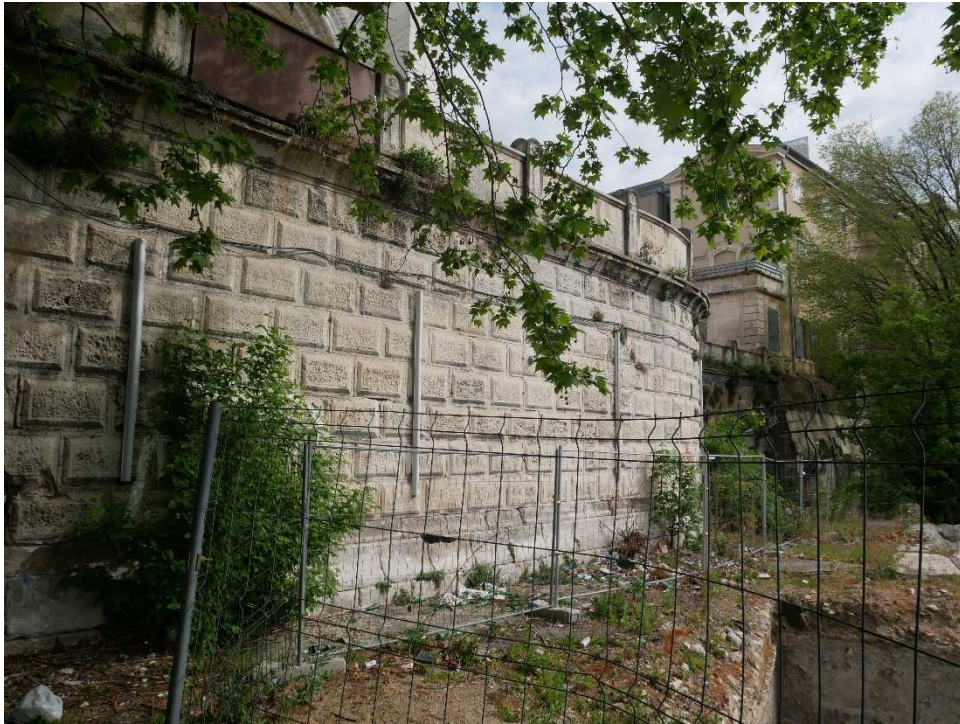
Photo du mur M1, bossage, corniche et balustrade / EQ 2021
